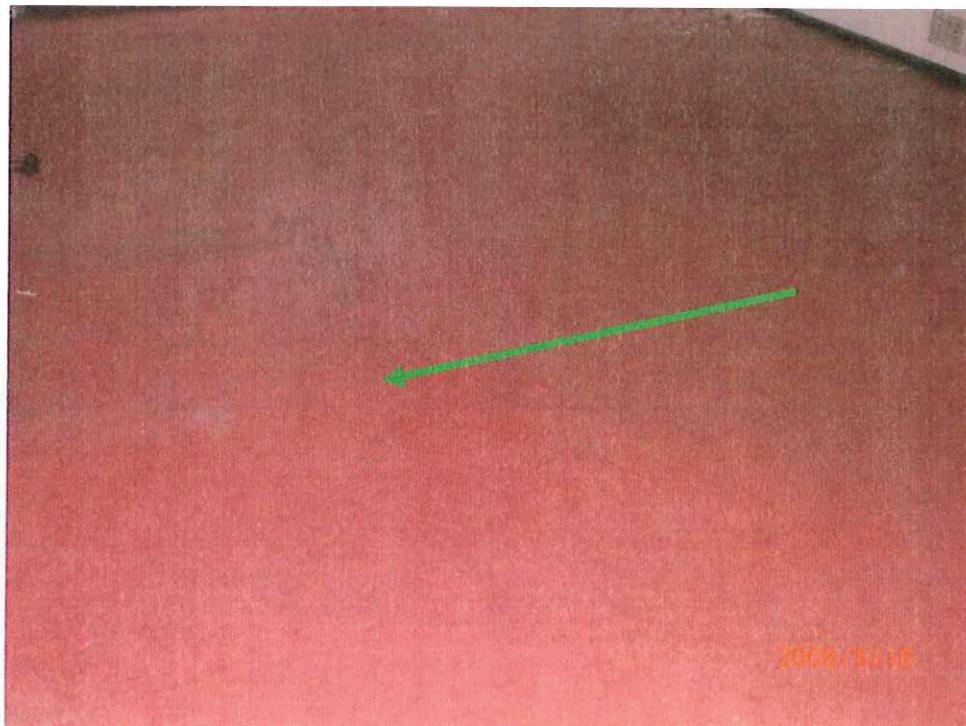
Bâtiment A – Niveau 0 – Bureaux – Plinthe – *NEGATIF
